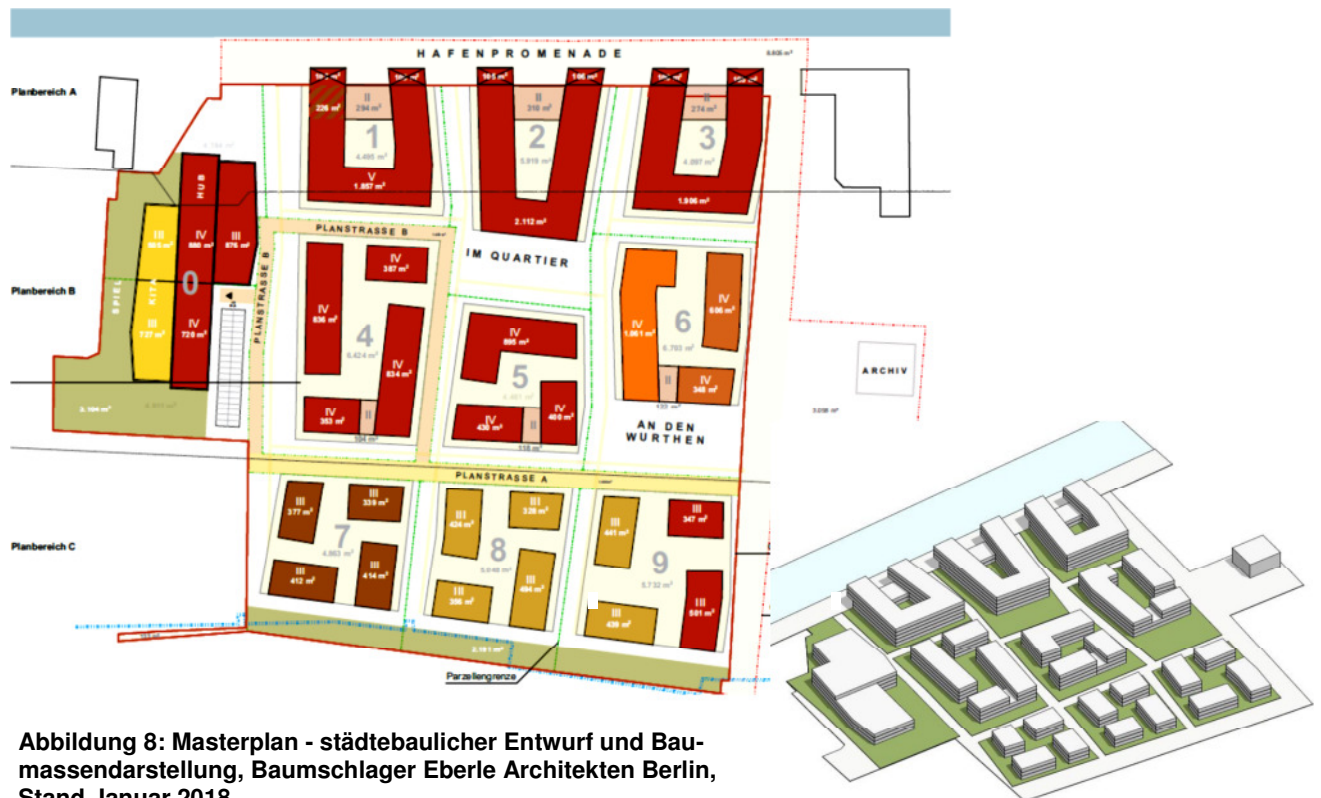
Masterplan - städtebaulicher Entwurf und Bau-massendarstellung, Baumschlager Eberle Architekten Berlin, Stand Januar 2018,
